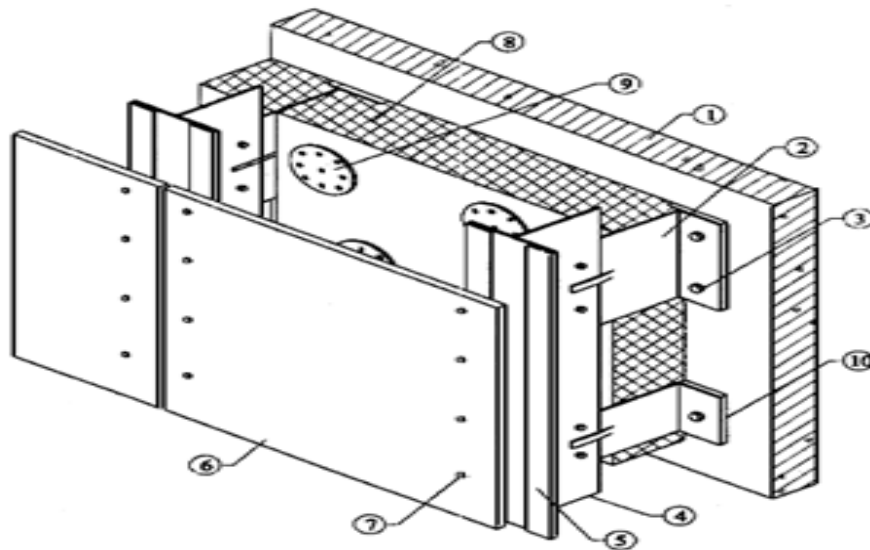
Системи з облицюванням плитами з плитами з фібро бетону. із прихованим кріпленням. Де: 1. Підстава. 2. Кронштейн. 3. Анкерний болт кріплення кронштейна. 4. Вертикальний профіль. 5. Гумова прокладка. 6. Облицювальна плита з фібробетону. 7. Саморіз кріплення облицювальної плити. 8. Утеплювач. 9. Тарілковий дюбель кріплення утеплювача. 10. Паронітова прокладка.
